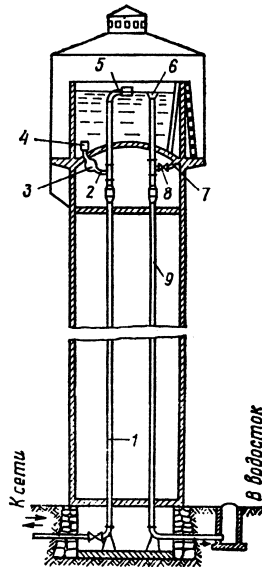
Схема оборудования водонапорной башни трубопроводами:
